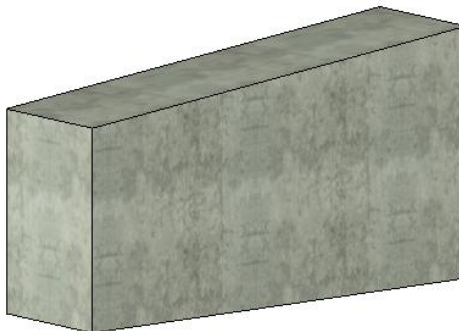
Vista 3D de zona maciça de viga de inércia variável
